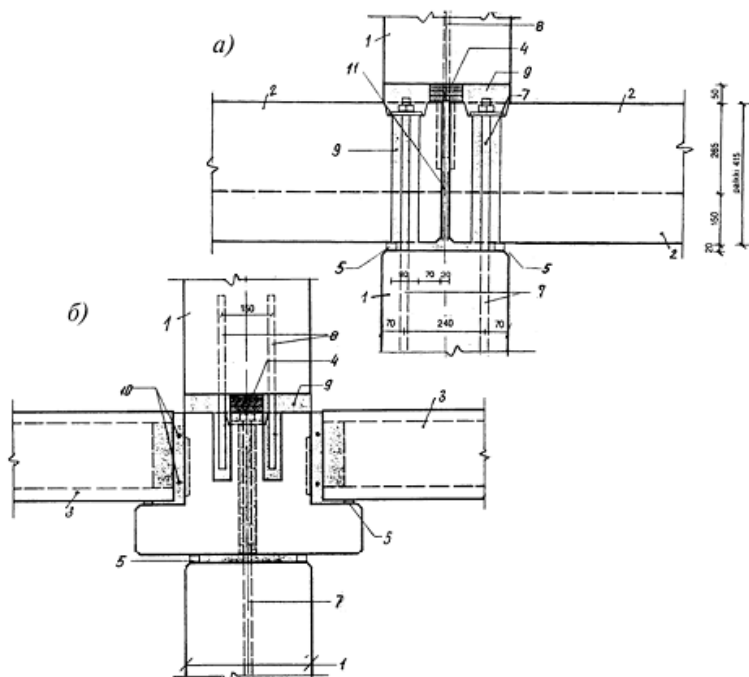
Вариант сопряжения колонн поэтажной разрезки с дисками перекрытий
